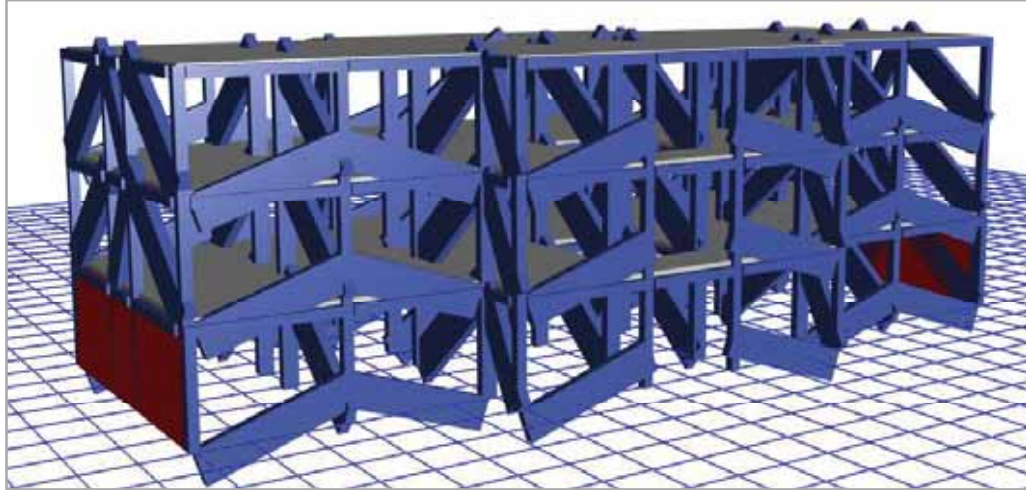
Propuesta de reforzamiento con muro de albañilería confinada.
